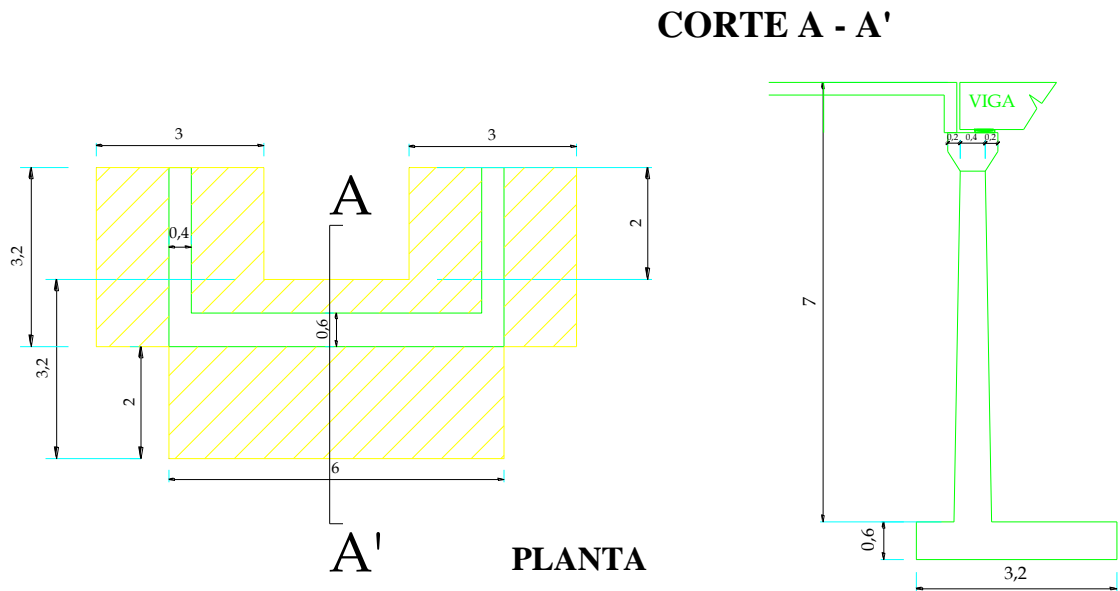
DETALLE DE LOS ESTRIBOS A UTILIZARSE EN LA AMPLIACIÓN.
